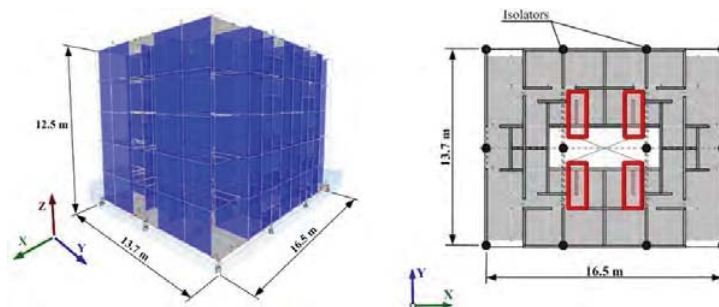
Estructura de referencia: a) Isometría estructural; b) Planta estructural
